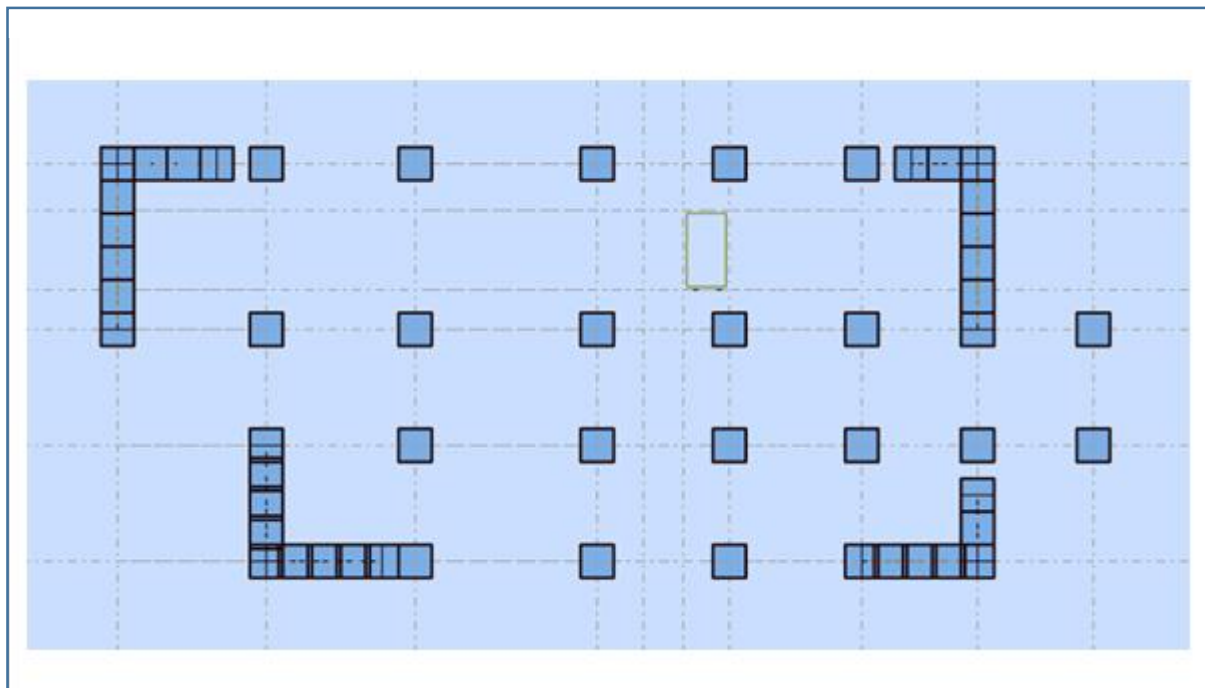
Vue en 2D et plan de la 2ème proposition.
